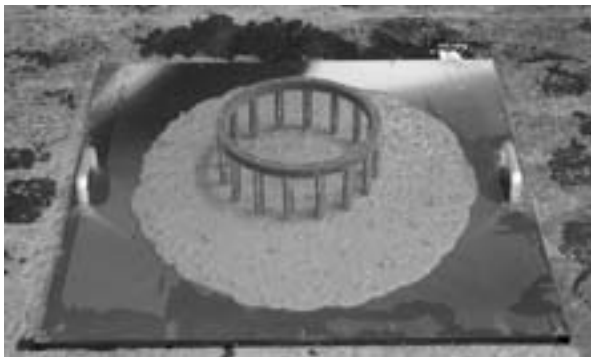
Setzfließmaß mit Blockiererringprüfung eines SVB (rd. 700 mm) auf Ausbreitplatte 900 mm × 900 mm
